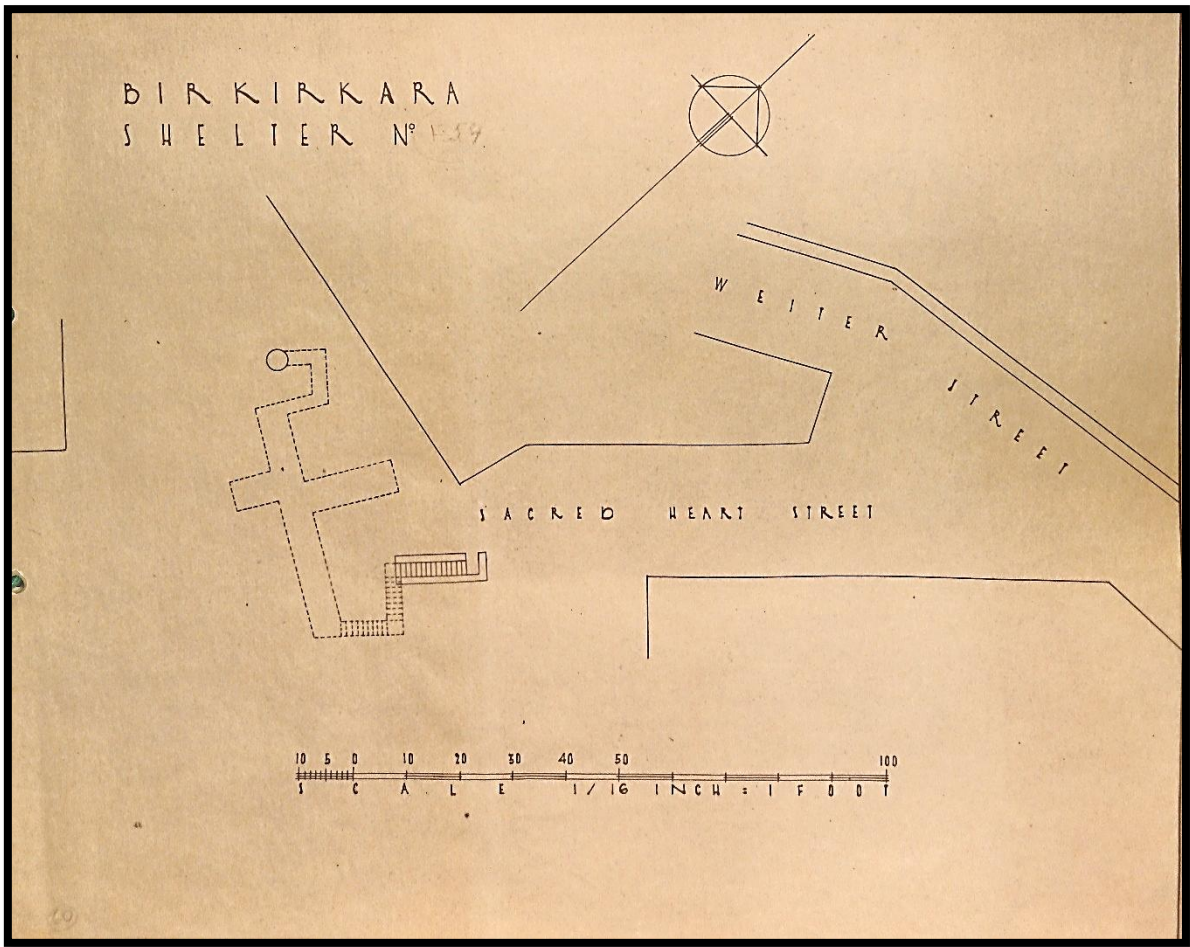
Planta do Abrigo nº54 (1) "Sacred Heart Street. – Weiter Street"
